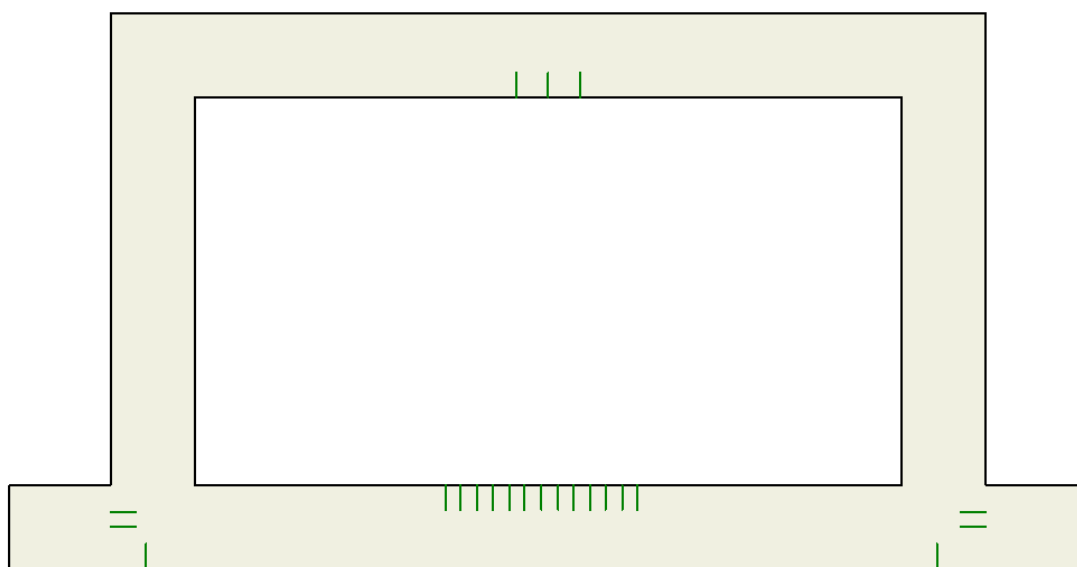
diagramma di involuppo della struttura fessurata, sezione tipo del canale di adduzione
